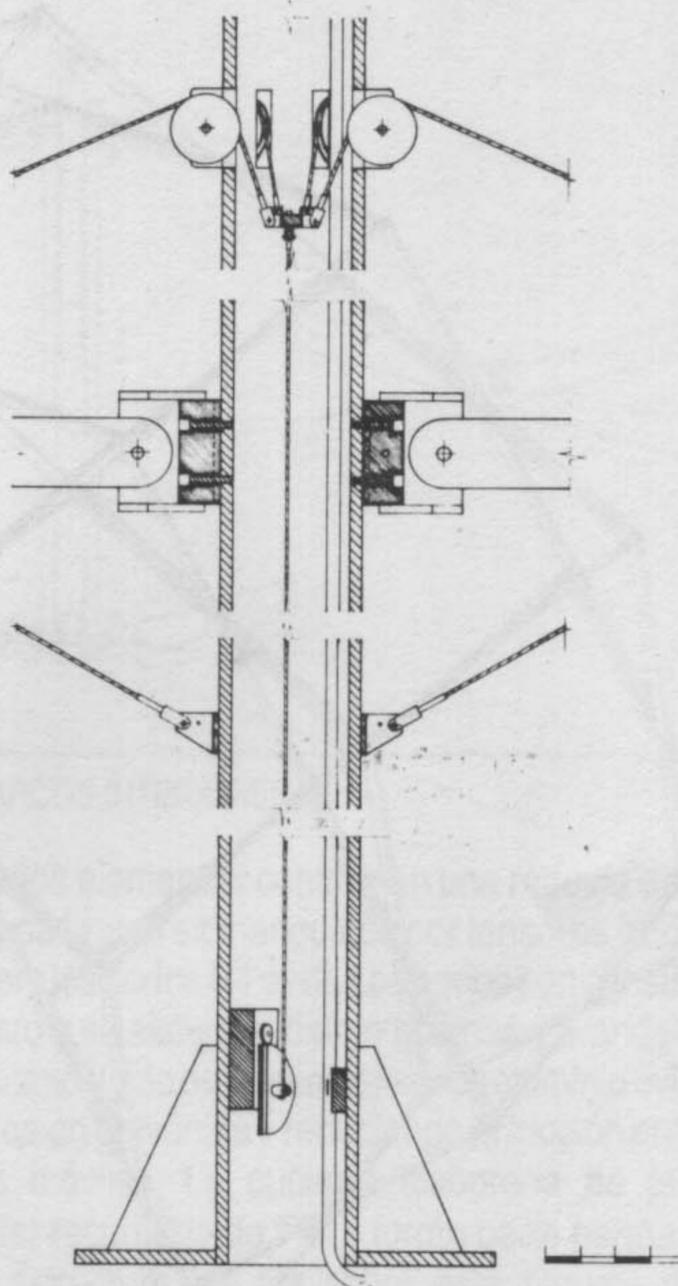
SECCION ATRAVEZ DE SOPORTE CENTRAL
